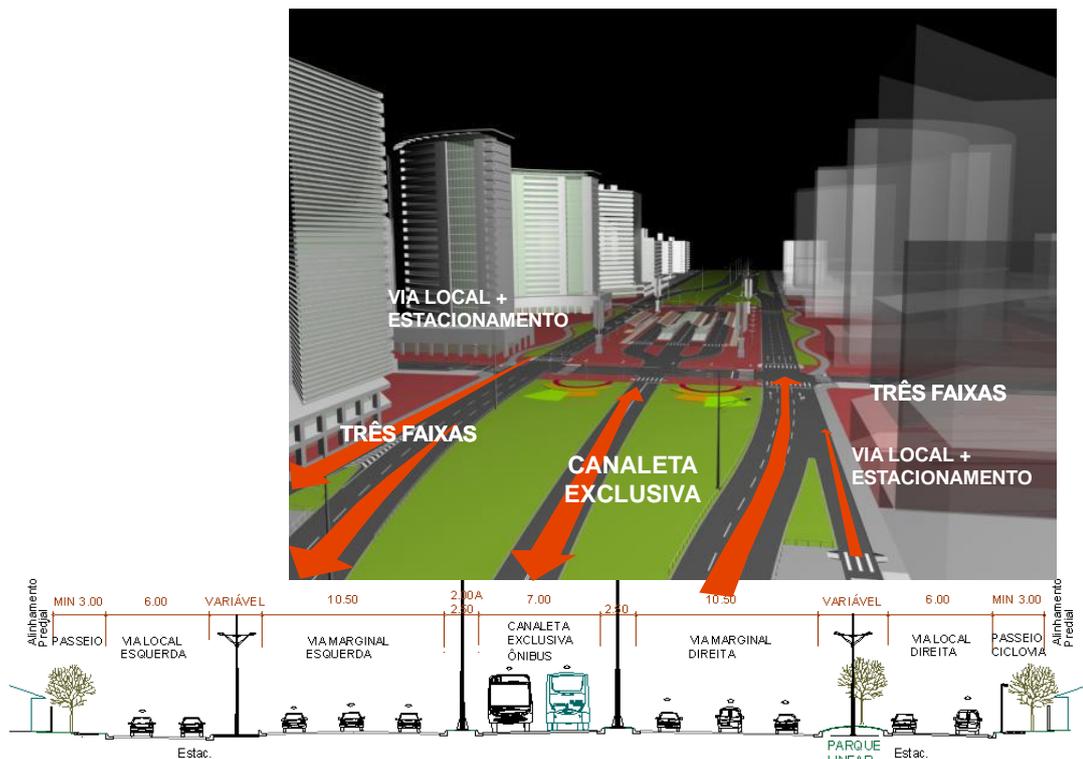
Seção Transversal da proposta do sistema viário do Projeto Linha Verde
